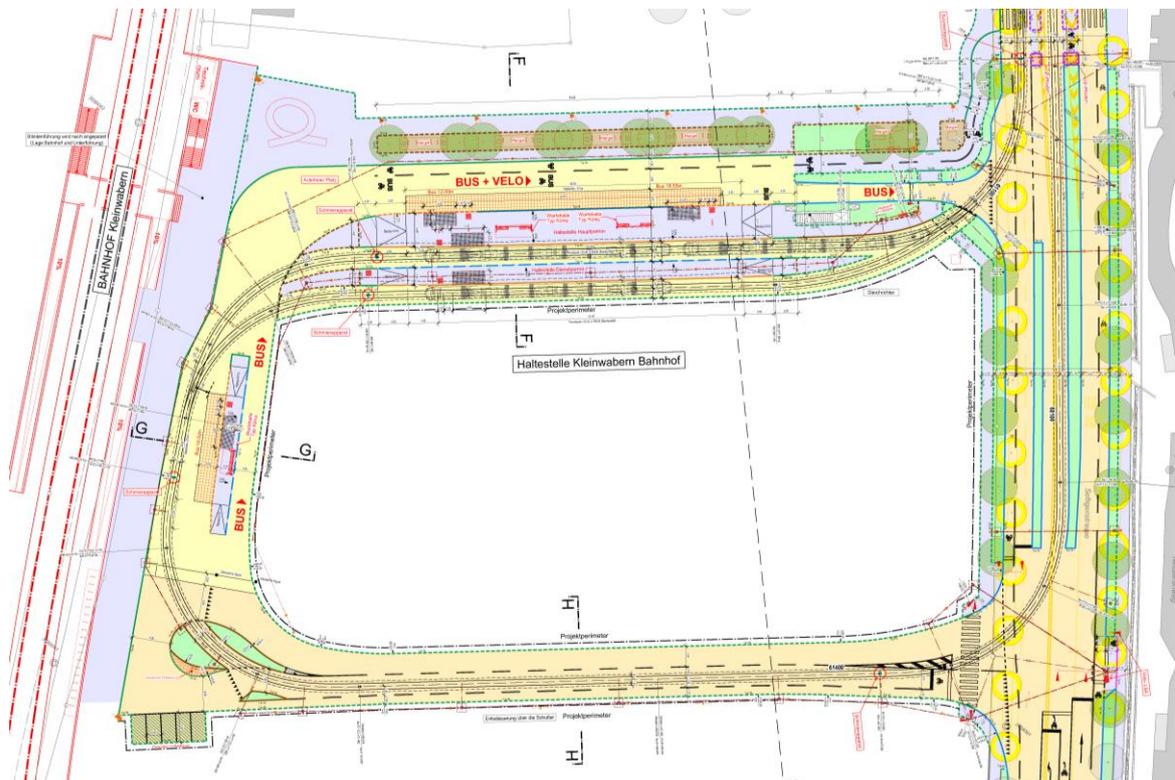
Bereich Wendeschleufe, Kleinwabern Bahnhof, Planausschnitt aus Situationsplan
